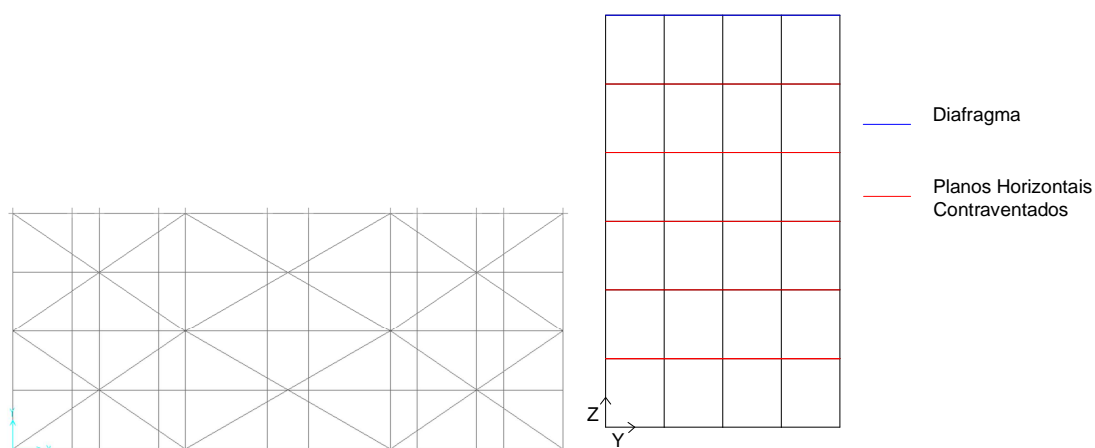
Configuração dos Planos de Contraventamento Horizontal Com Elementos de Contraventamento Grandes
